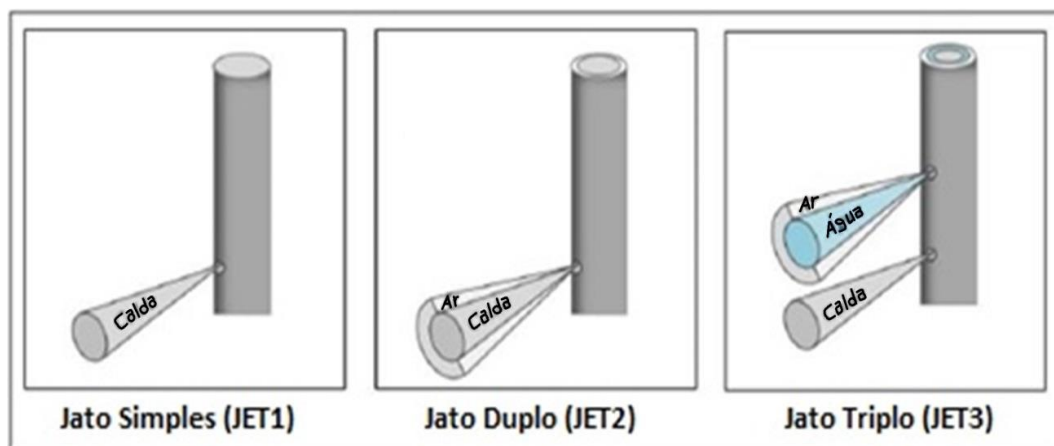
Sistemas de aplicação do jet grouting (modificado de Vergara, 2013).
